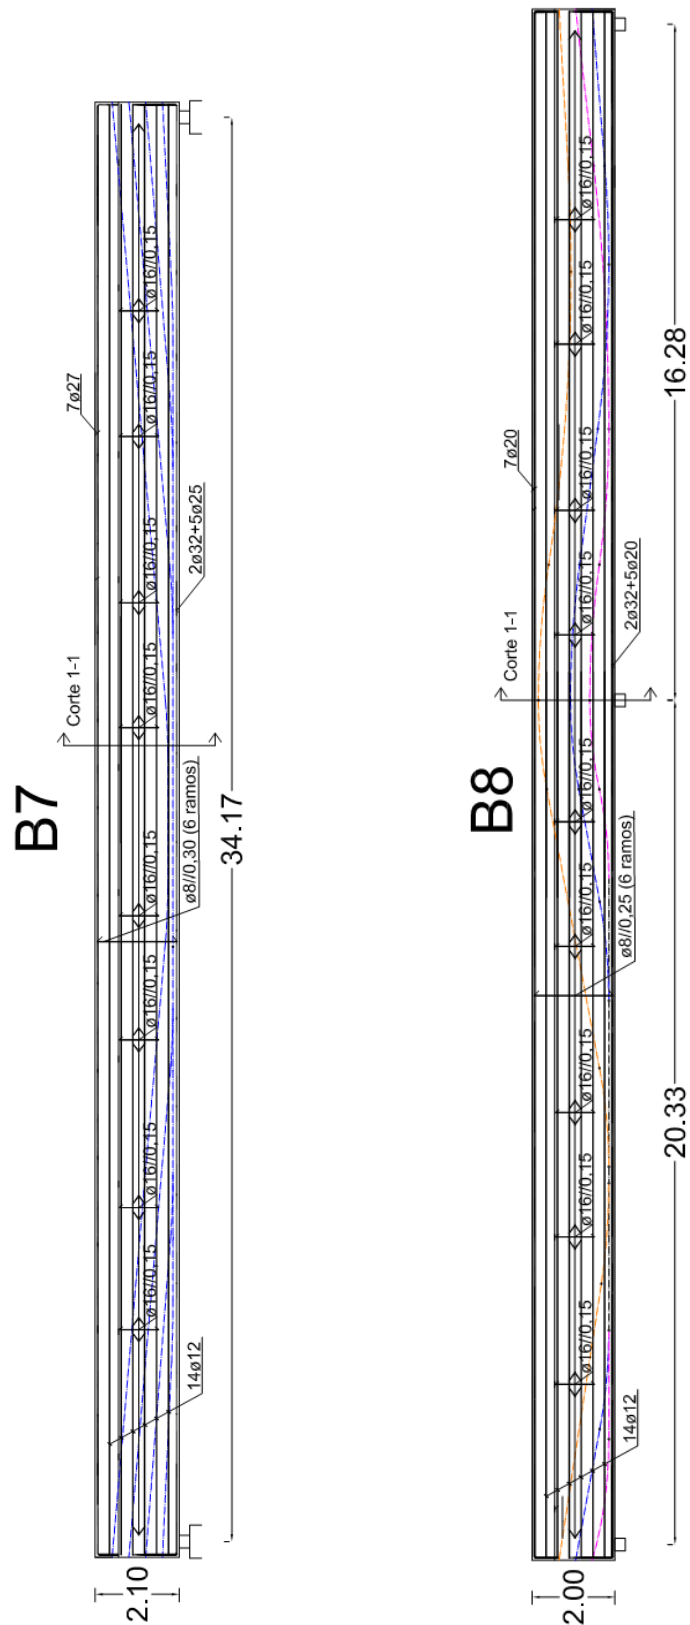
Armaduras das vigas pré-esforçadas (corte em alçado)
